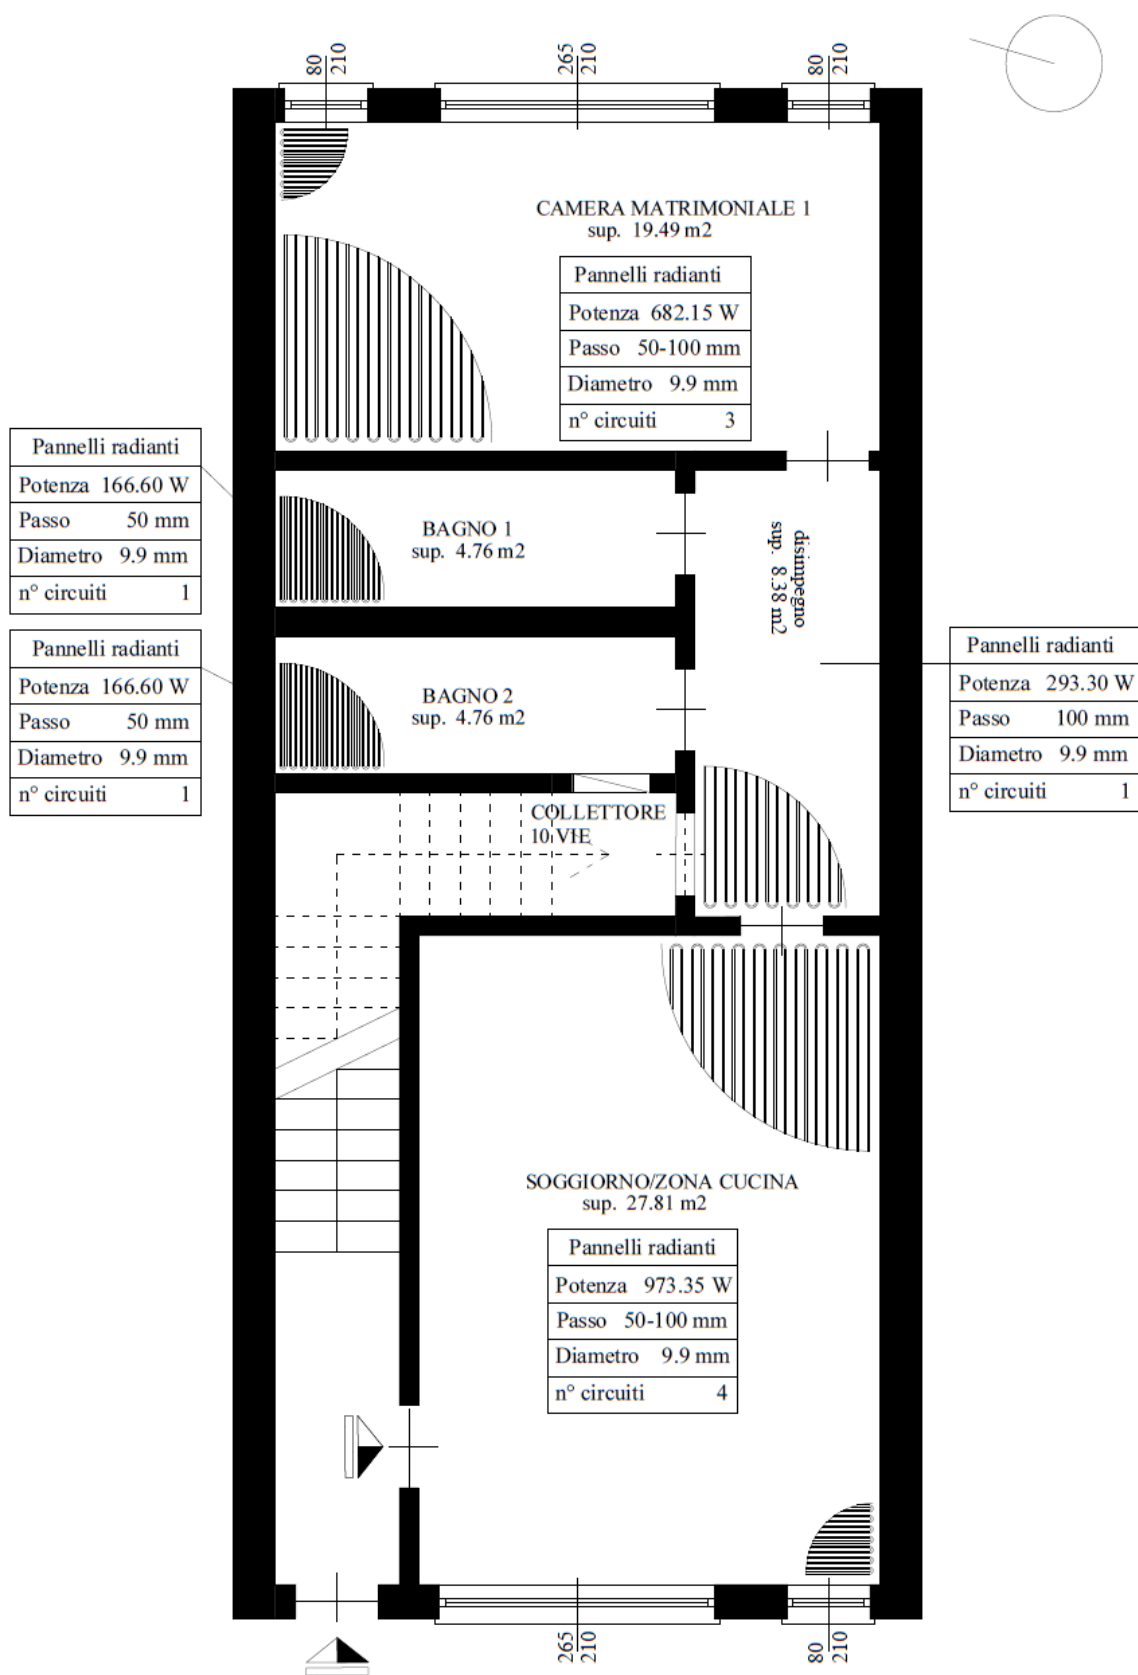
Planimetria con indicazione dei massetto radiante dimensionato, su Autocad (elaborazione a cura dell'autrice)
